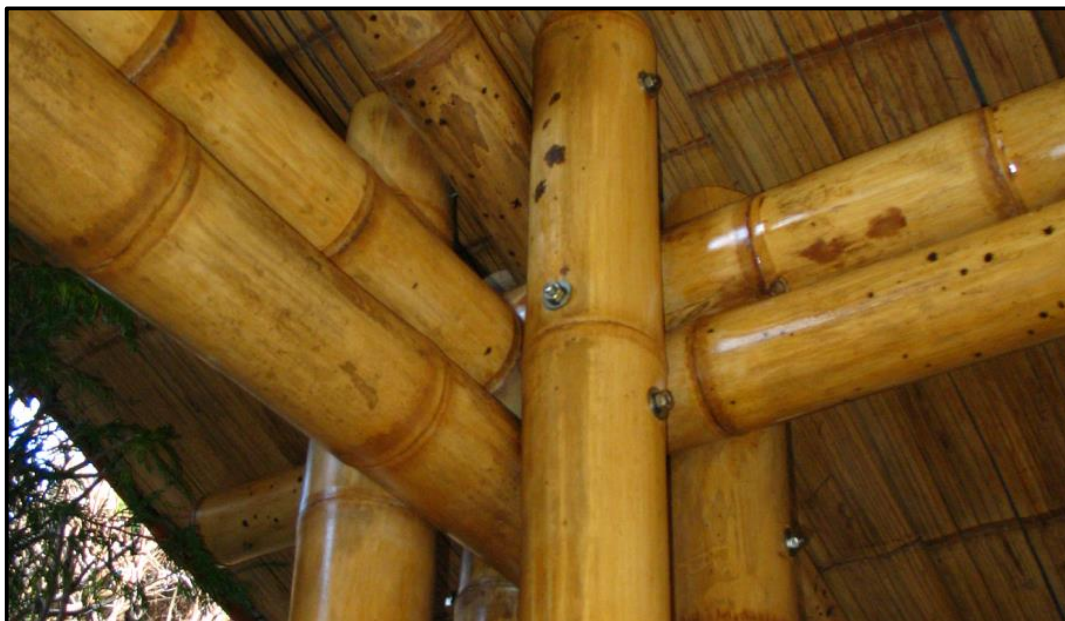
Vigas compuestas de bambú en la estructura de un garaje. Fuente: Bambusa (2014).
